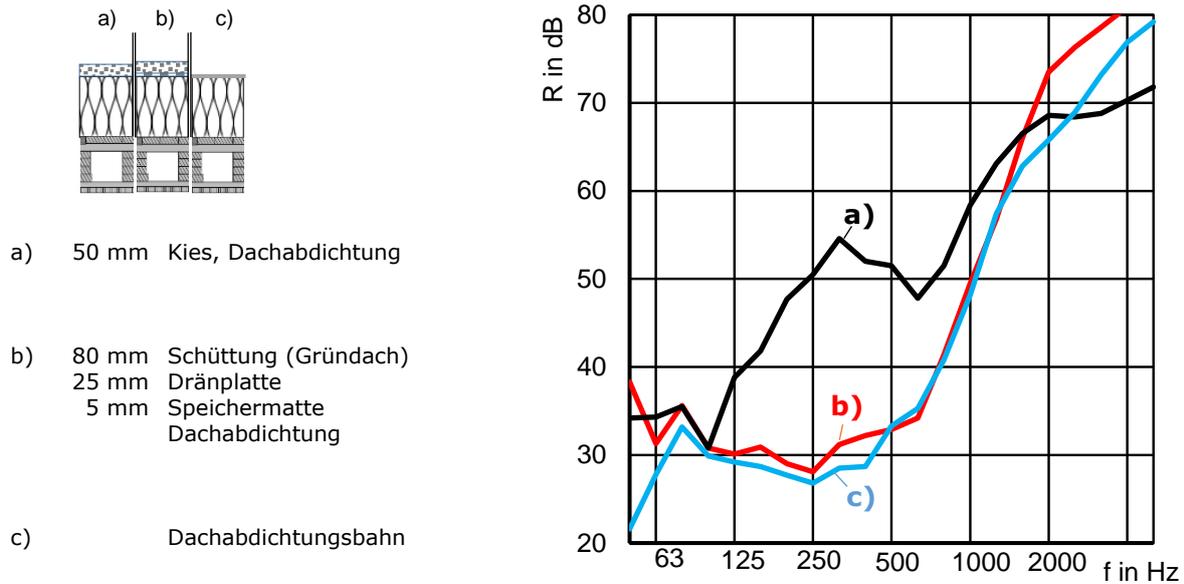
Vergleich der Aufbauten: Kiesdach, Gründach und einfache Dachabdichtungsbahn auf einem Brettsperrholz – Kastenelement mit 200 mm EPS Aufdachdämmung
